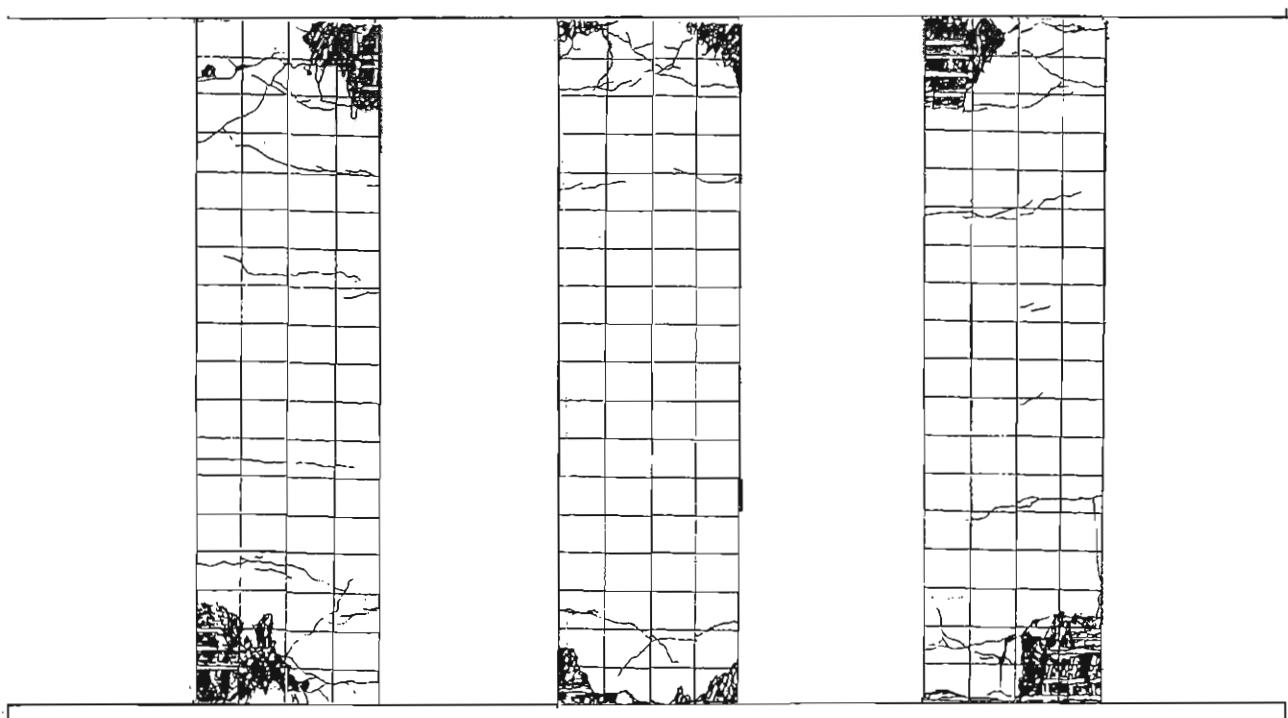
桁体のひび割れ状況展開図 (ケース4、7δy)
